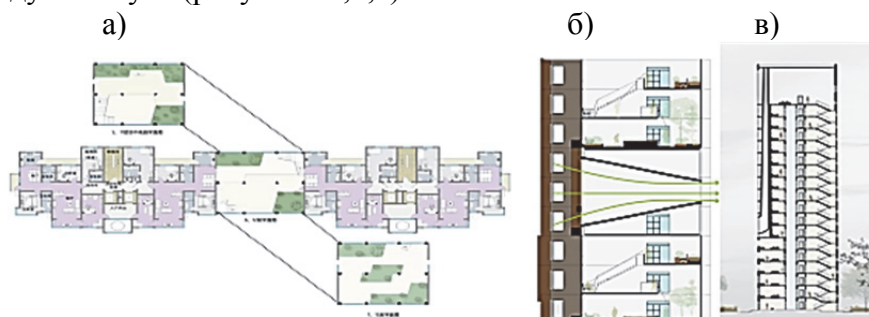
а) План эксплуатируемой кровли; б) Частичное поперечное сечение «висячего сада»; в) Вид поперечного сечения воздуховода лифтового холла
